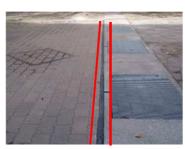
人工芝グランドへの施工例 写真-7 インターロッキング舗装道への施工例
